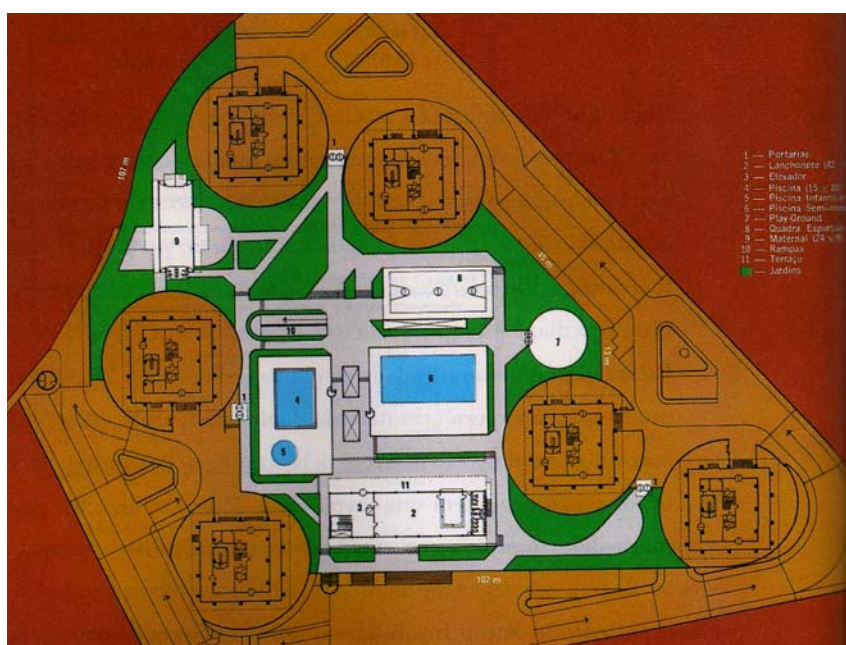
Planta da área de lazer. Fonte: SACCHI, 2003, p. 112.
